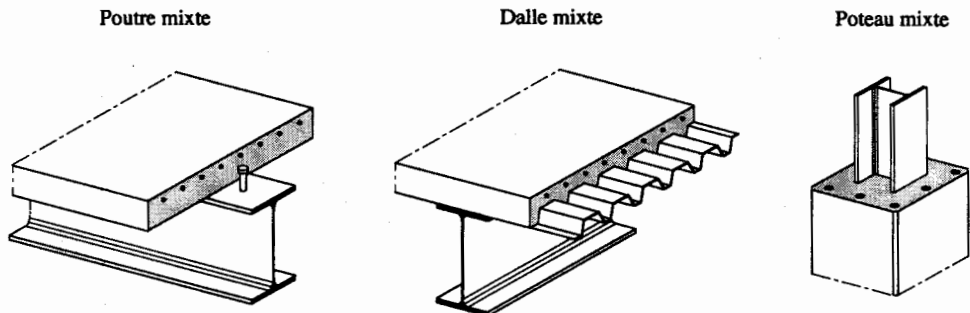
Exemples d'éléments mixtes acier-béton.
